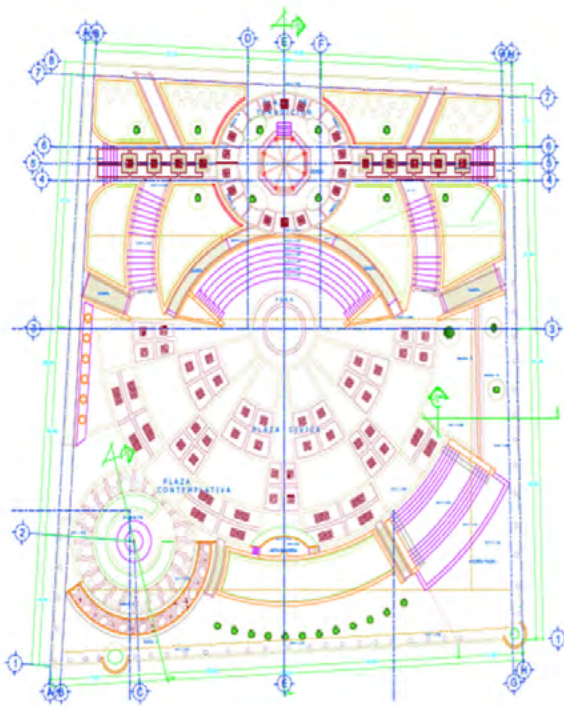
Planta arquitectónica (en su estado actual) de la Plaza Miguel Hidalgo, Temoaya, Estado de México
